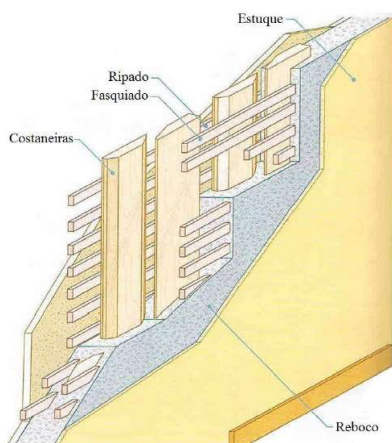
esquema de uma parede tradicional em tabique (Appleton, 2003).
